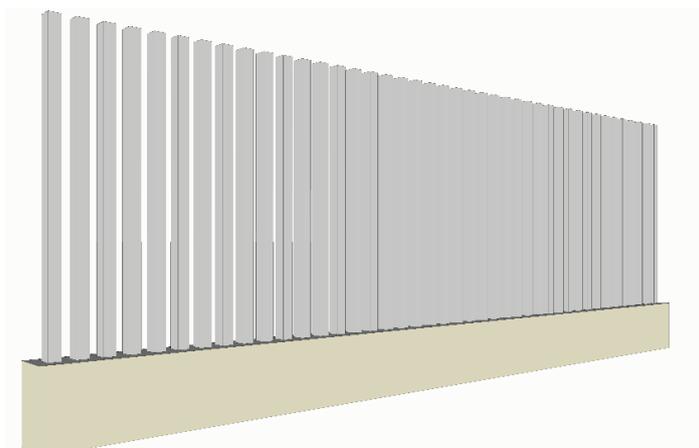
Vista prospettica della recinzione della SSE utente di trasformazione
